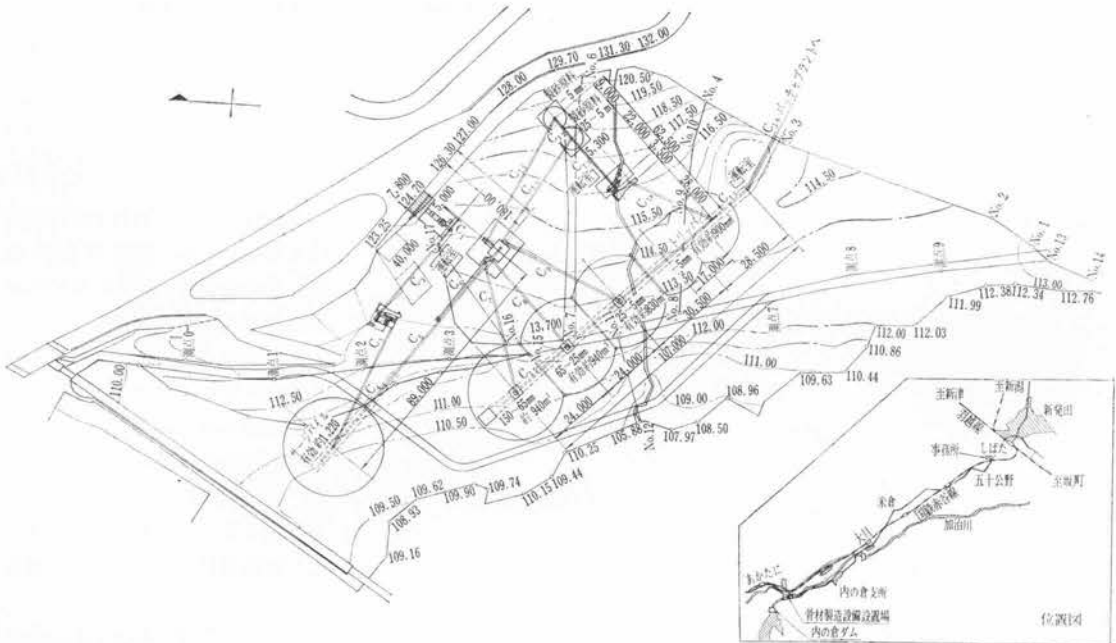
内の倉ダム骨材製造設備平面配置図(その2)
